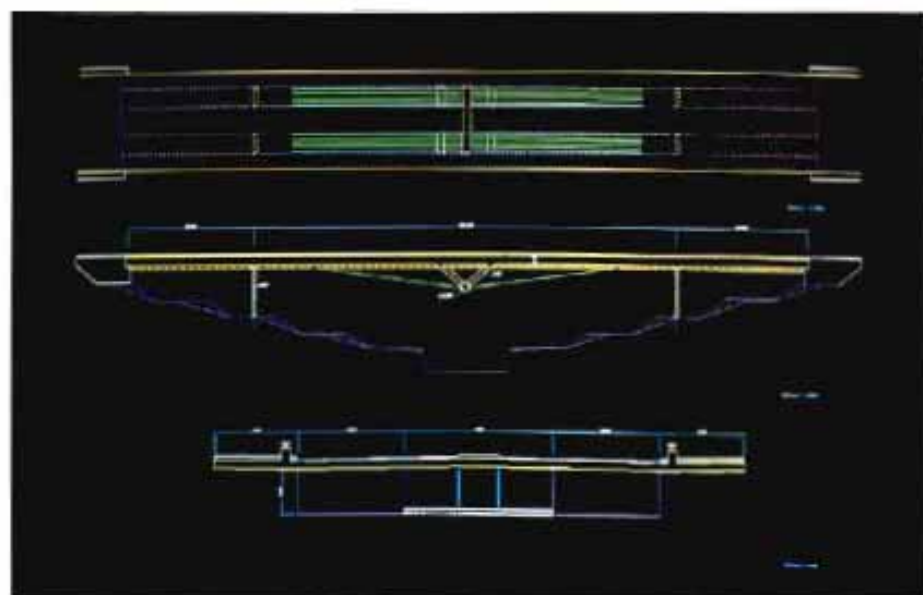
Puente mixto sobre el río Vinalopó en Elche, para concurso.
